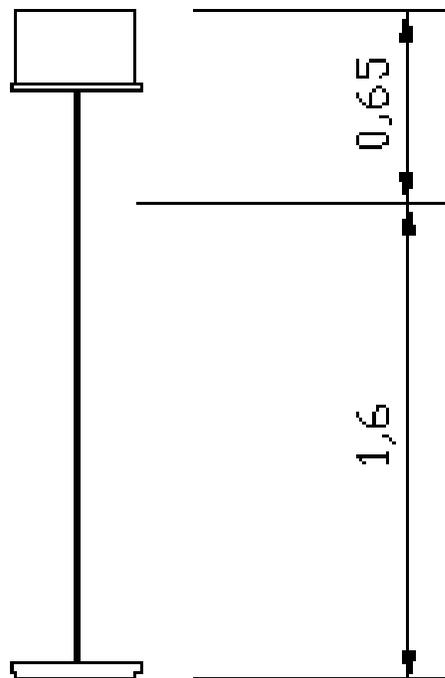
Diseño de viga metálica con losa colaborante. Sección viga en etapa de Servicio. Con sección transformada de H.A. a acero.
